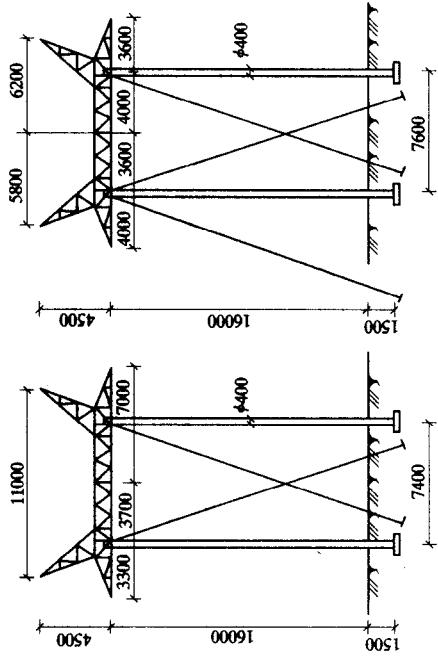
(a) 220kV 钢筋混凝土拉线门型承力杆
